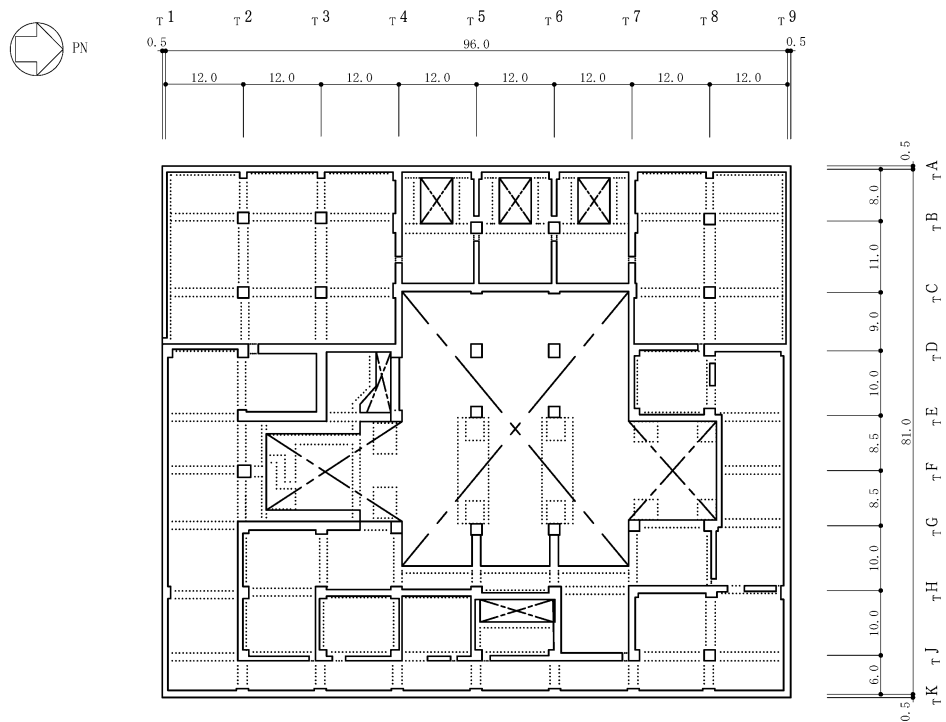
タービン建屋の概略平面図 (B1F, T. M. S. L. 4.9m) (2/6) (単位 : m)
